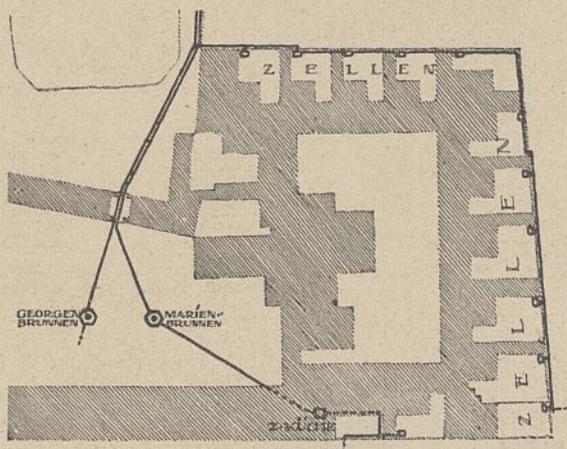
Tüchelhausen, Schema der Wasserleitungsanlage. (Nach Plan und Beschreibung von 1805.)
